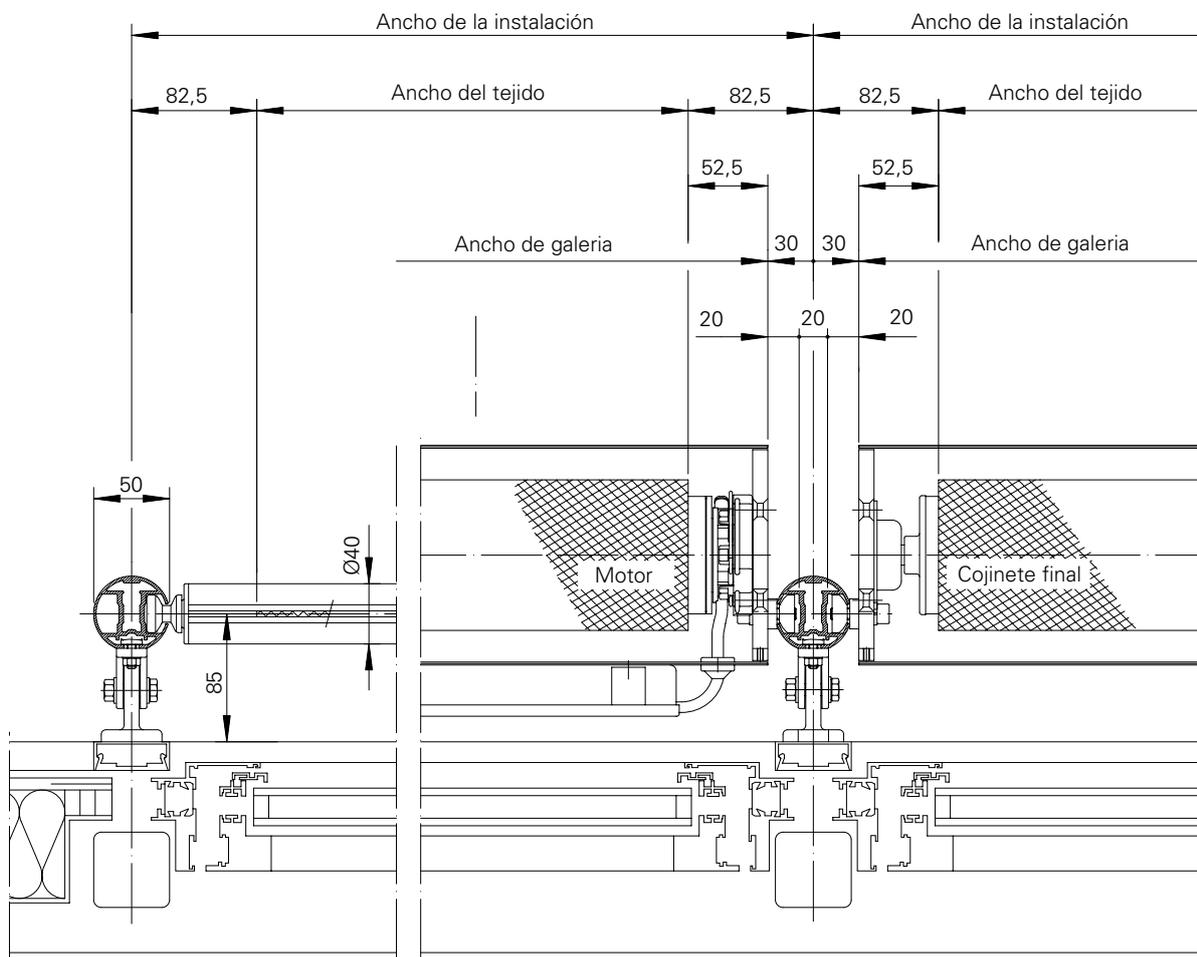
Sección horizontal toldo para fachadas modelo 201 E con protector redondo modelo 8.3, carril guía de 50 mm continuo
